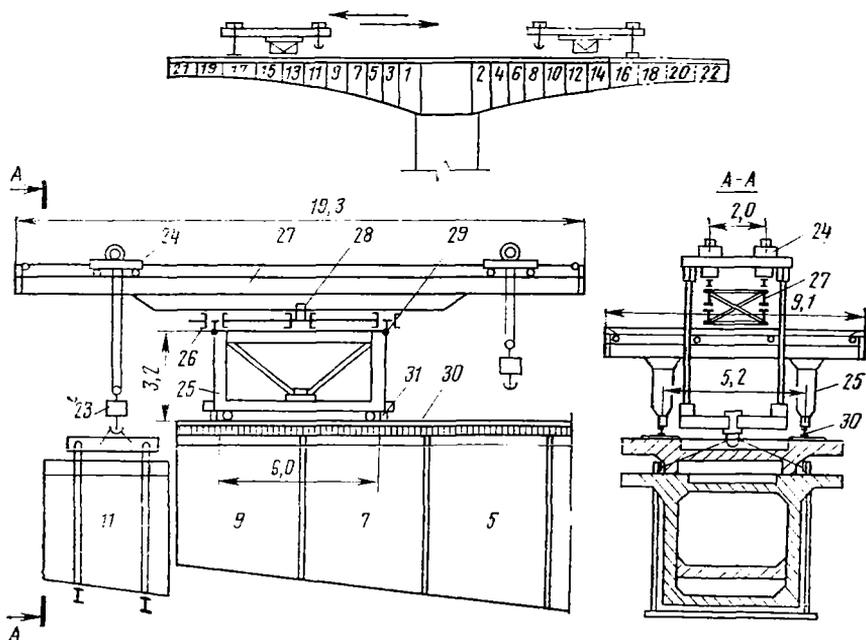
Схема навесного монтажа пролетного строения агрегатом СПК-35:
